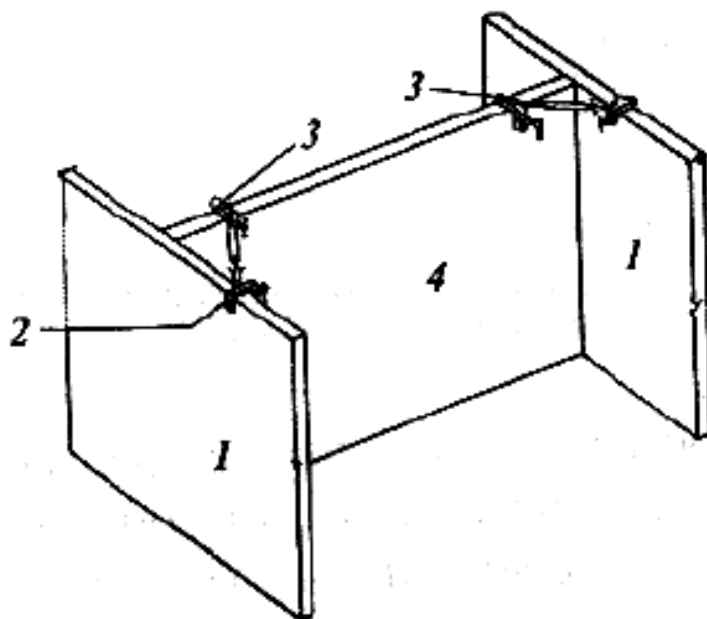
Схема крепления панели внутренней стены с помощью двух монтажных связей:
